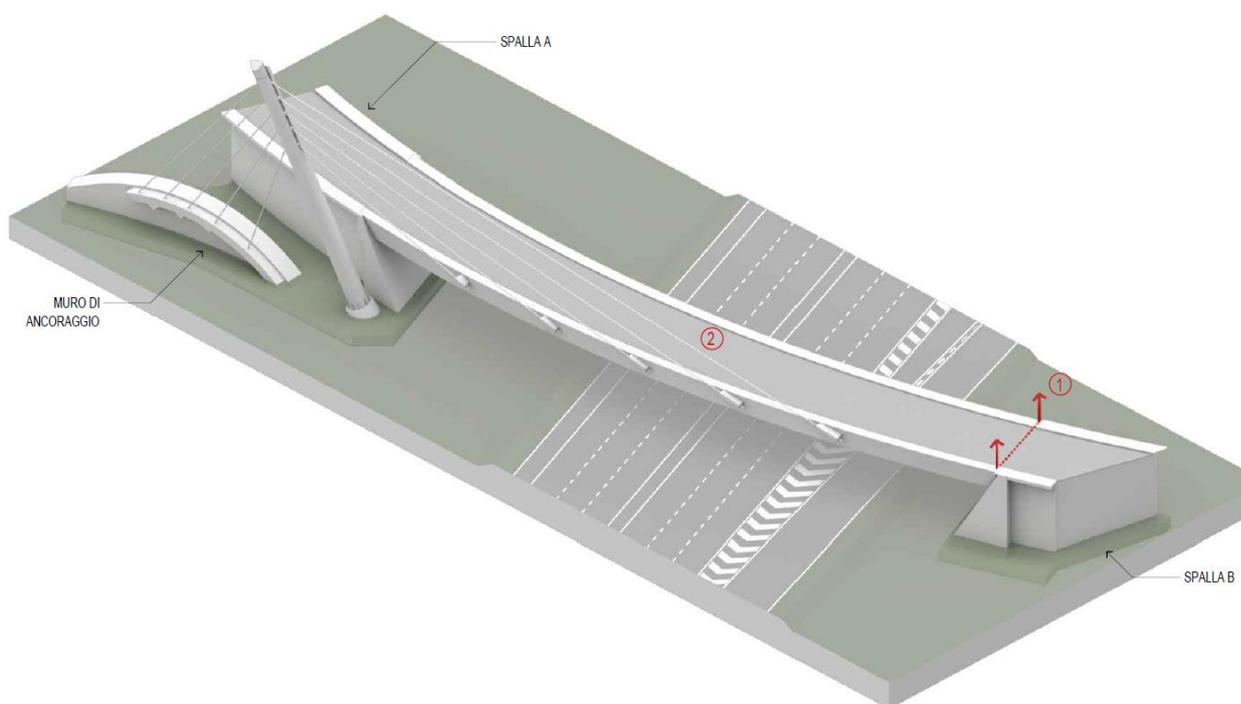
Applicazione delle distorsioni di progetto dell'impalcato per tramite degli appoggi spalla B; realizzazione dei marciapiedi, pavimentazioni
